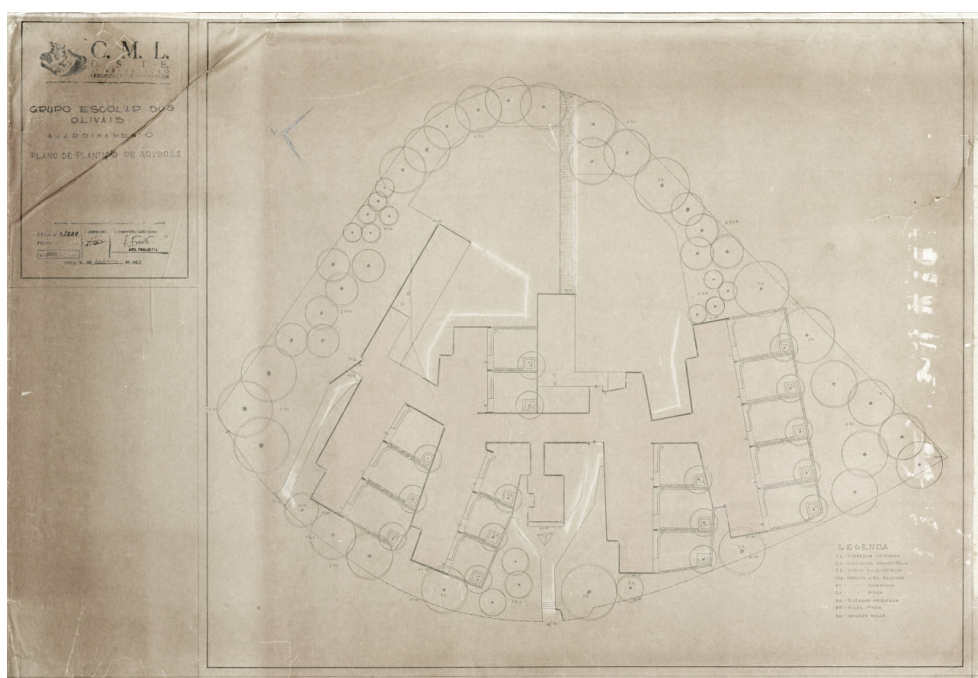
Grupo escolar dos Olivais. Ajardinamento. Plano de plantação de árvores. Sampaio Fontes, 1963.
